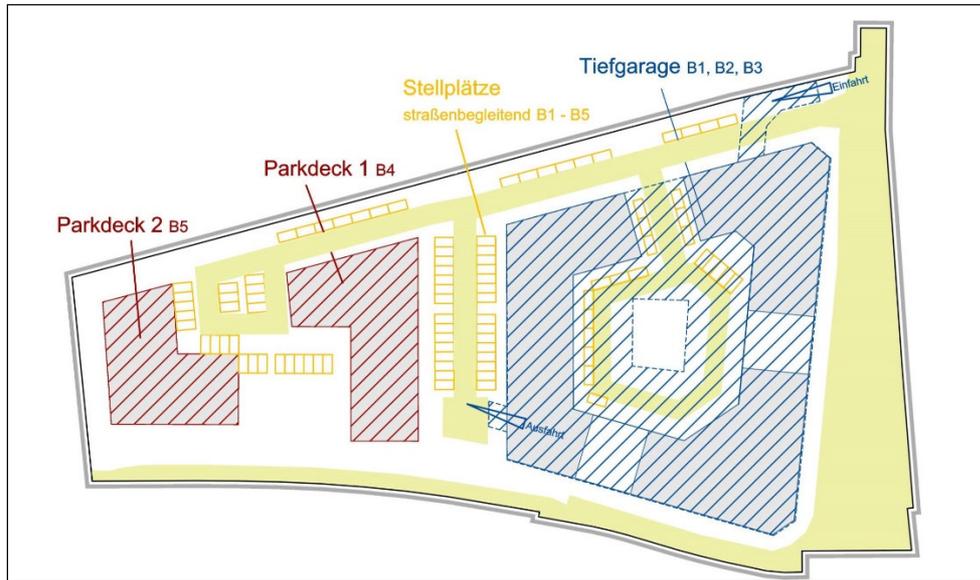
Darstellung der geplanten Stellplatzflächen im Plangebiet
